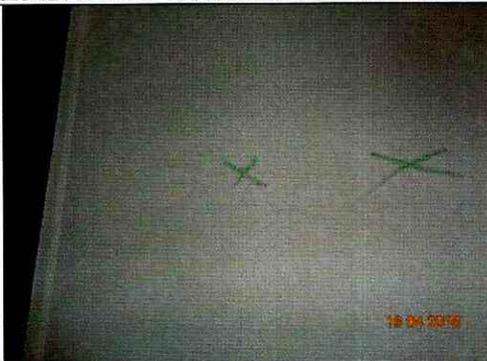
Fisuras evidenciadas al interior de los apartamentos
